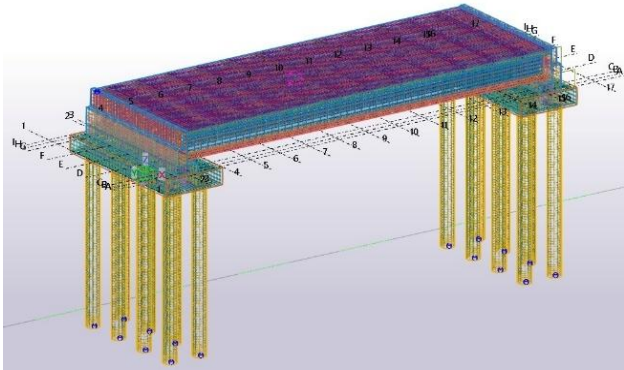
Hasil detail pemodelan komponen struktur abutment
